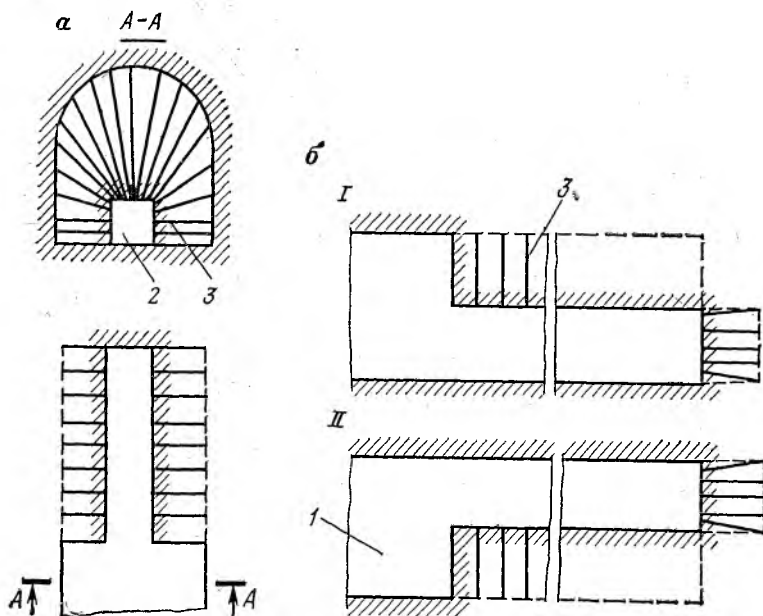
Схема проведения выработок-емкостей передовым забоем: I — с верхним уступом; II — с нижним уступом; 1 — выработка-емкость; 2 — передовой забой; 3 — скважинные заряды
